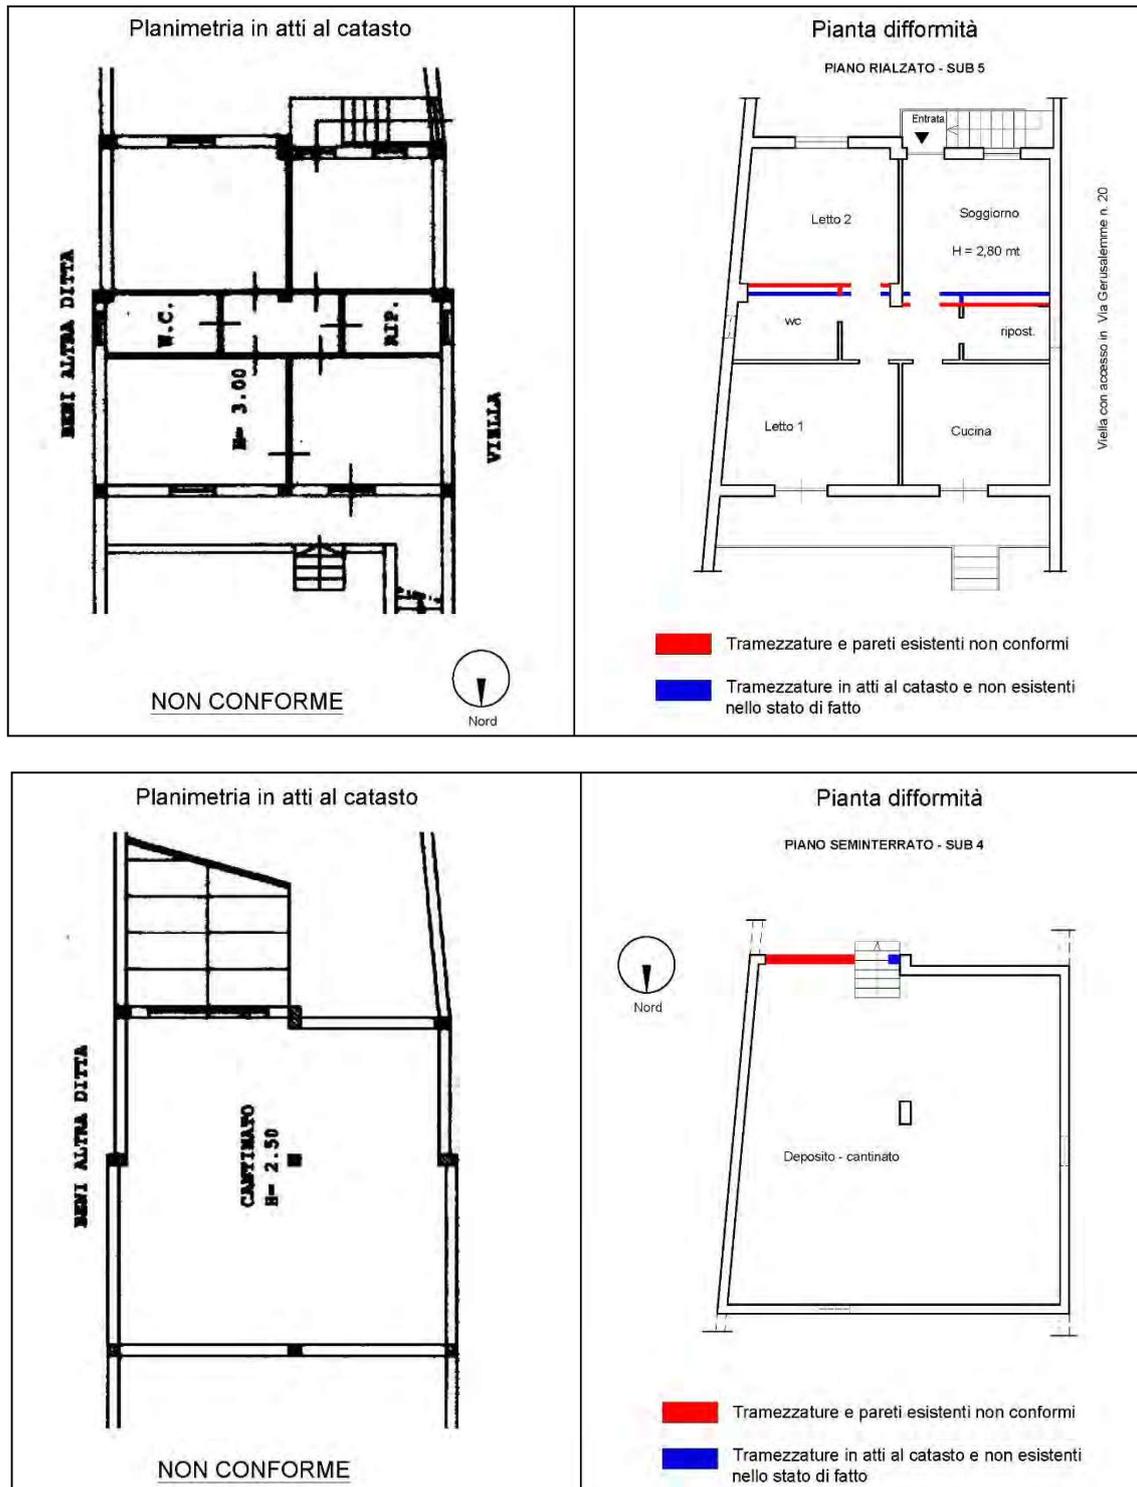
Confronto delle Planimetrie in atti al Catasto con lo stato dei luoghi (alleg. 4)
